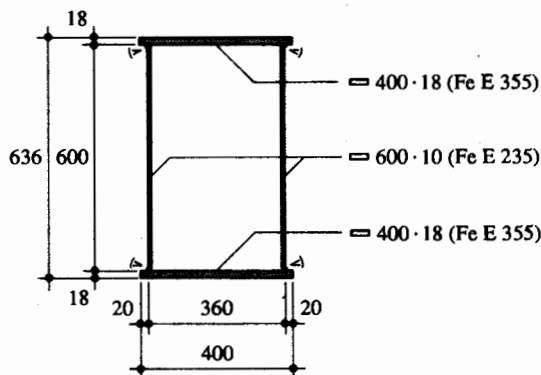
Exemple de section transversale d'une poutre en caisson.
